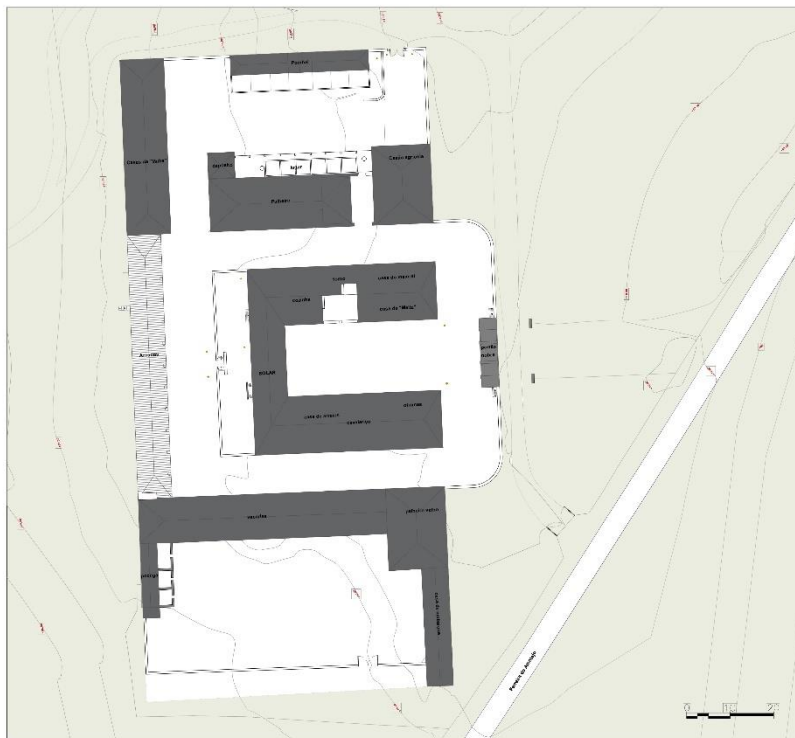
Planta da Estrutura antes da Intervenção - Monte do Rio Seco
